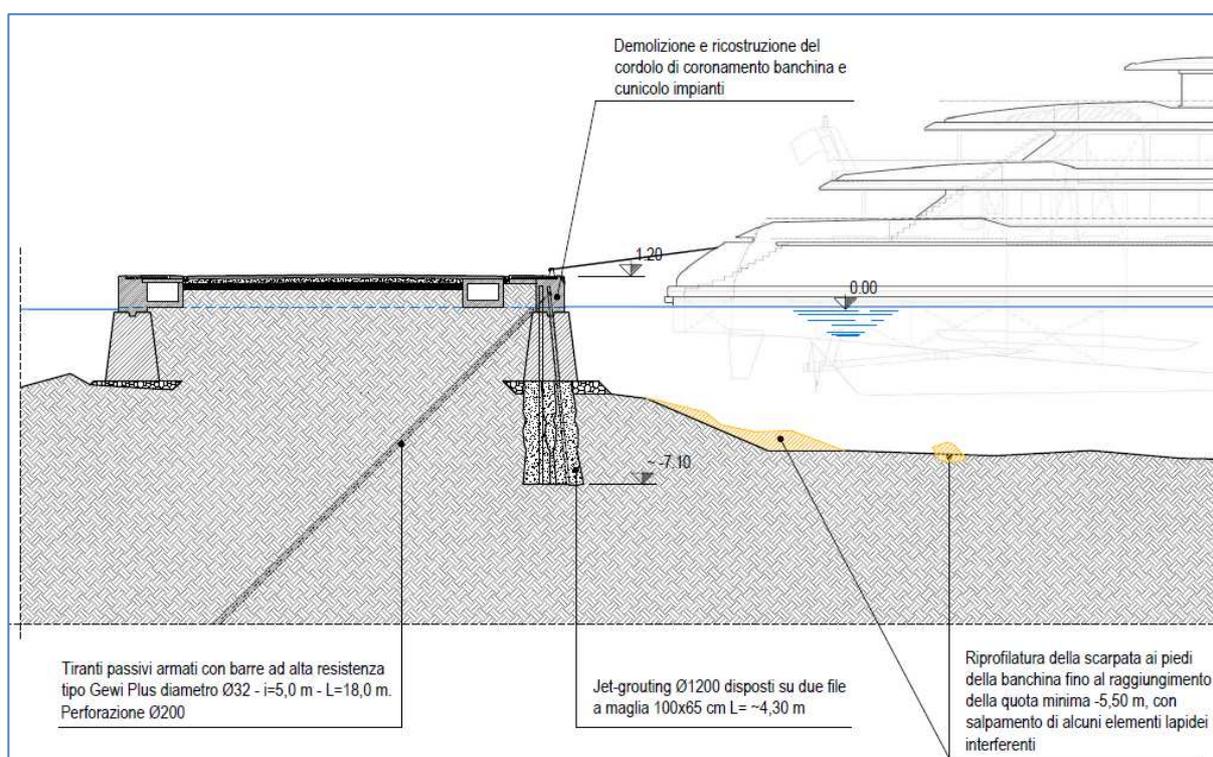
Sezione tipo rinforzo banchina Molo Langano
